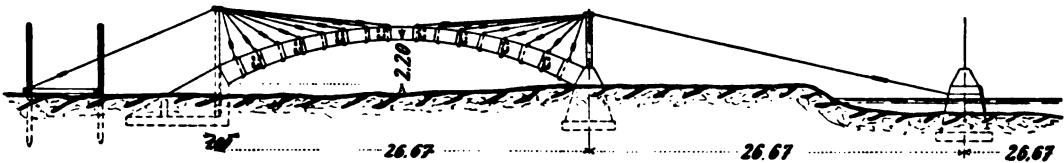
Aufhängeschema der Formstücke bei der Belviderebrücke.
